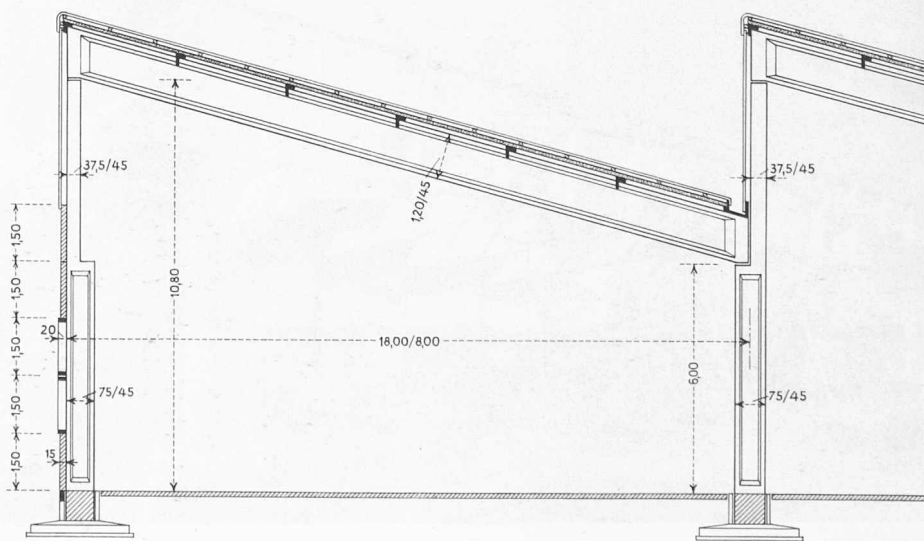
Shedhalle aus geraden Elementen für Serienfertigung, Masstab 1:200
